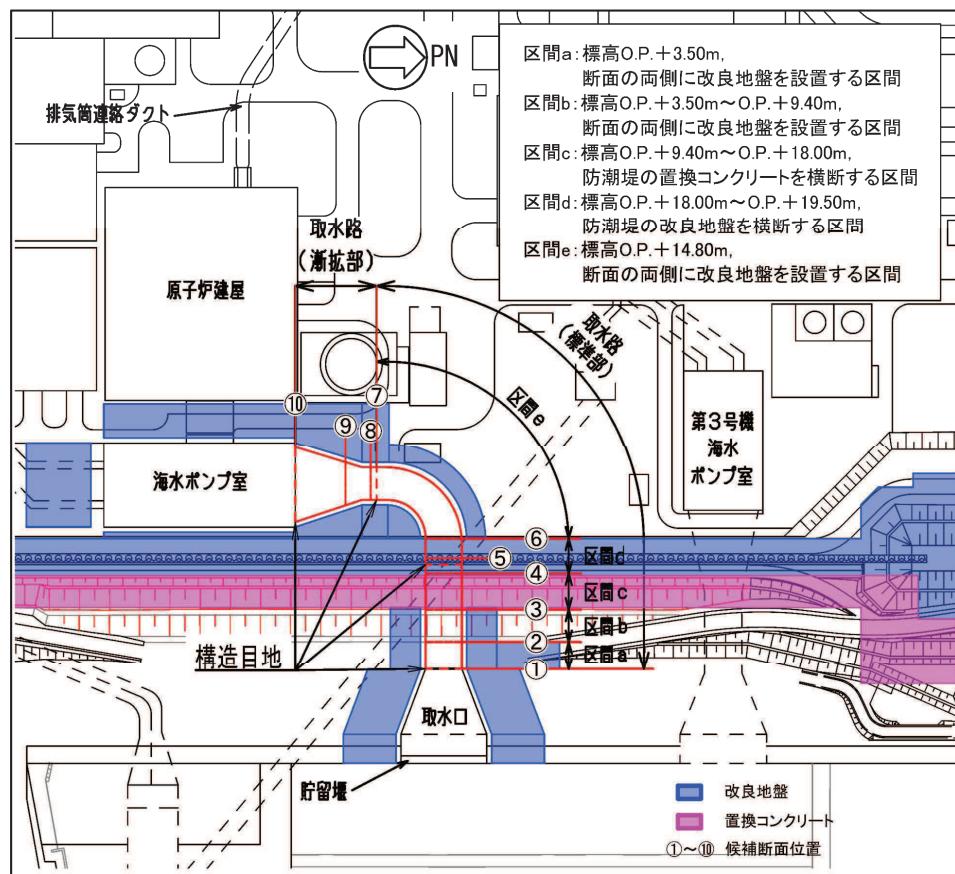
取水路平面図 (区間及び候補断面位置)
